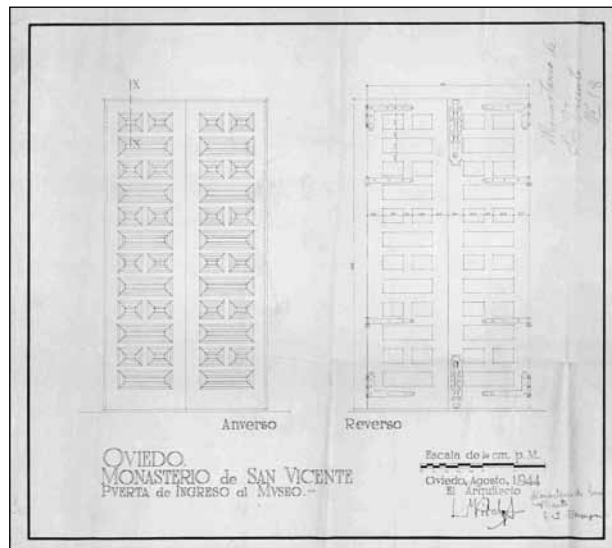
Planos de los detalles constructivos del proyecto de restauración del claustro de San Vicente dirigido por Luis Menéndez Pidal. Planoteca del IPCE (6168 y 6171)
